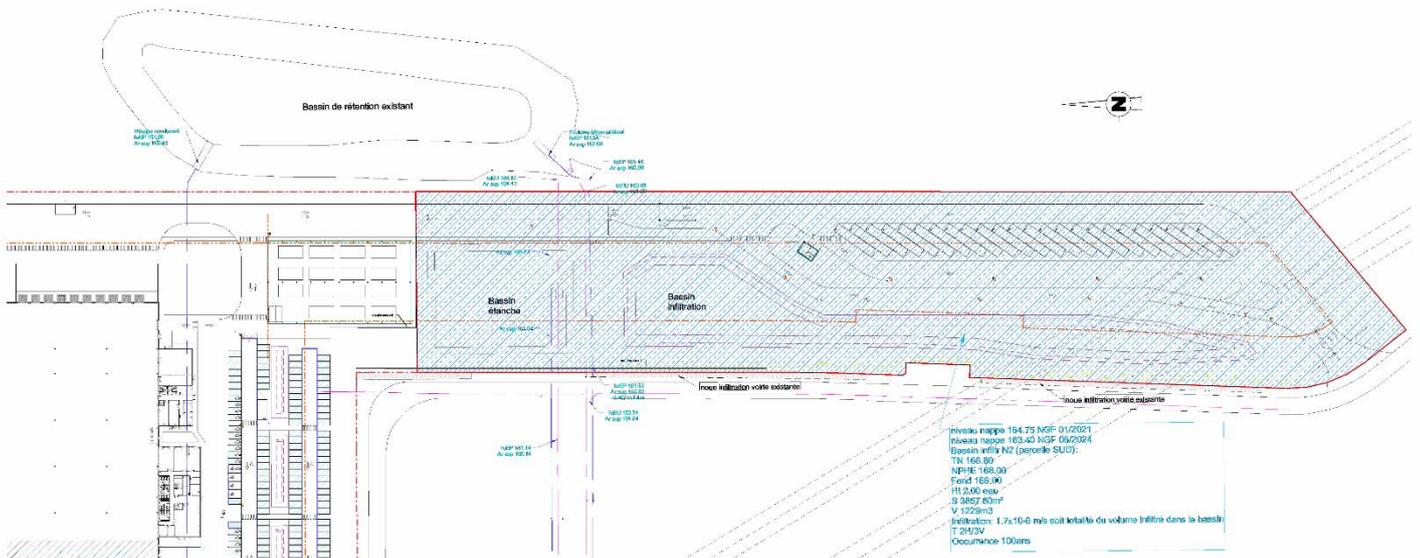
Extrait du plan de masse VRD (Source : BEG, Pierre et Pierre, Artelia, Chaussea)
